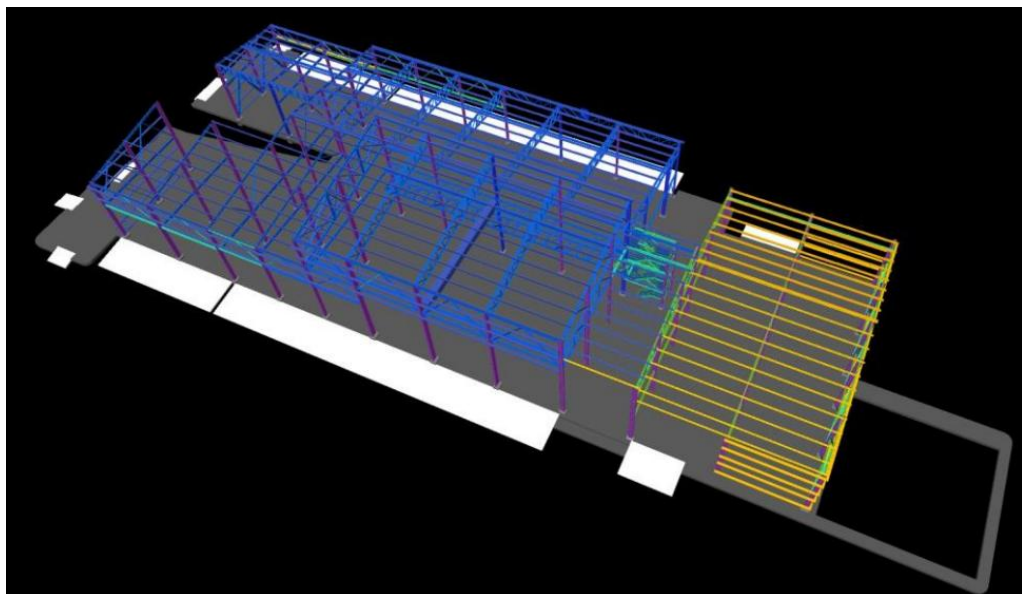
Montaje de vigas de amarre y correas en techo-fachadas
